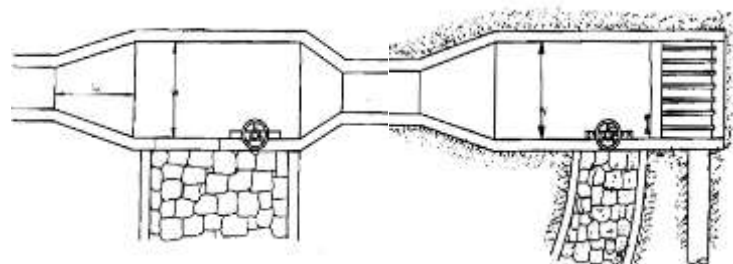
Esquema de desarenador y cámara de carga vista en planta.
